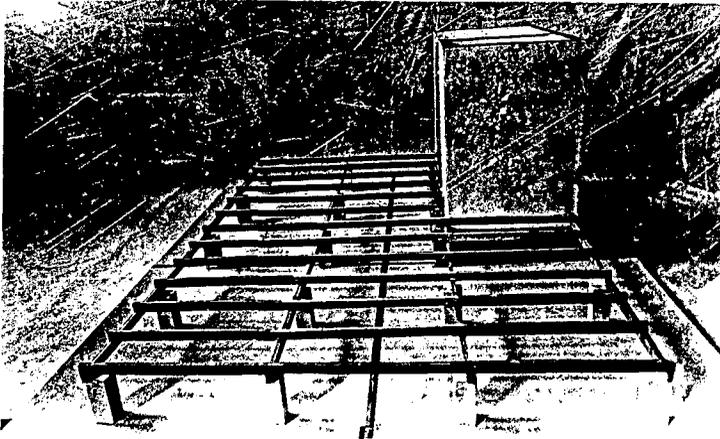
Barroteamento de piso colocado transversalmente às vigotas.
